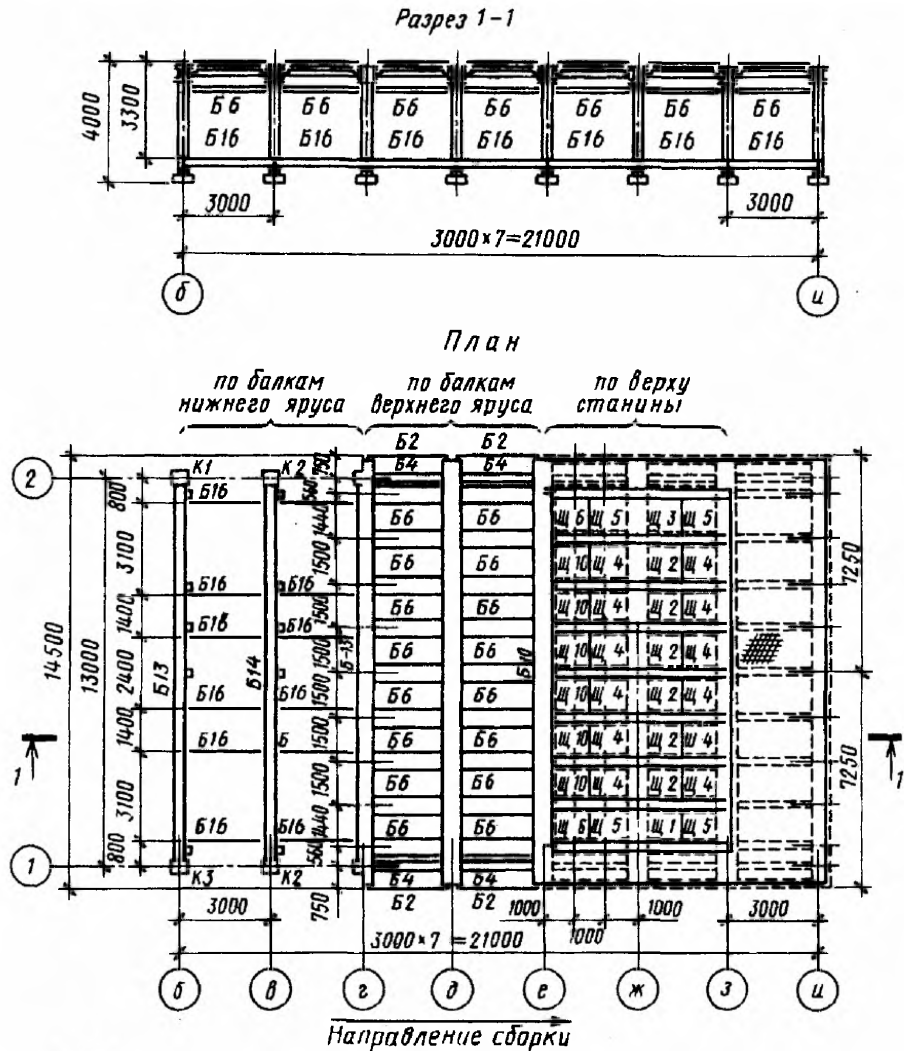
Монтажный чертеж опорных конструкций станины сварочного стана
